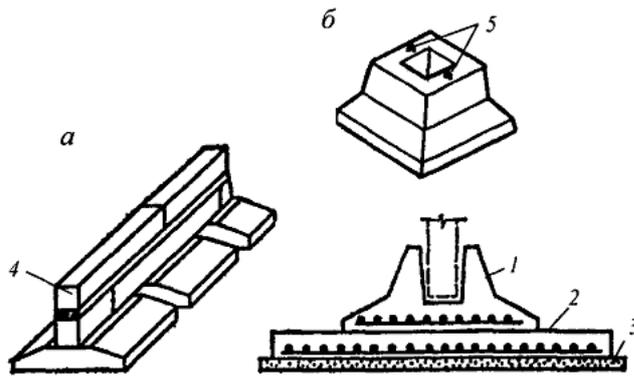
Сборные фундаменты: а – под стену; б – под колонну:
